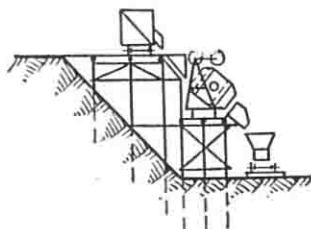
Бетоносмесительная установка у откоса подходной насыпи с использованием для загрузки бетономешалки высоты насыпи
